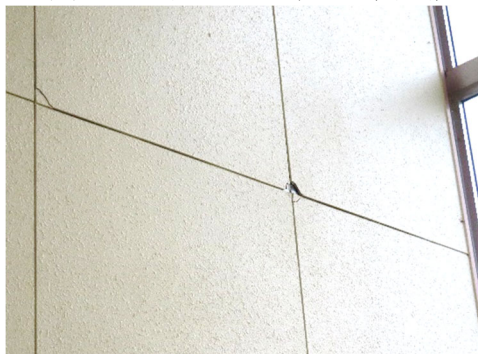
間仕切り壁のパネルの角部のひび割れ
